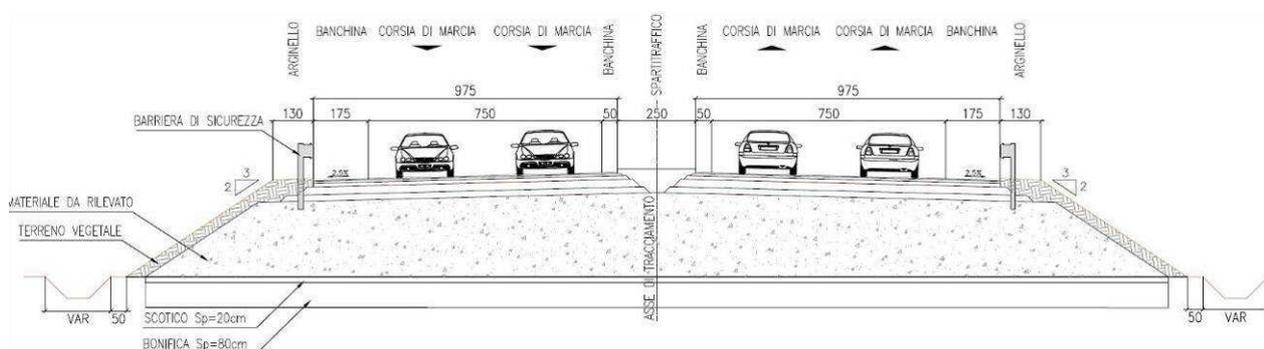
SEZIONE TIPO IN RILEVATO (ESTRATTO DALL'ELABORATO T00PS00TRAST01A)
